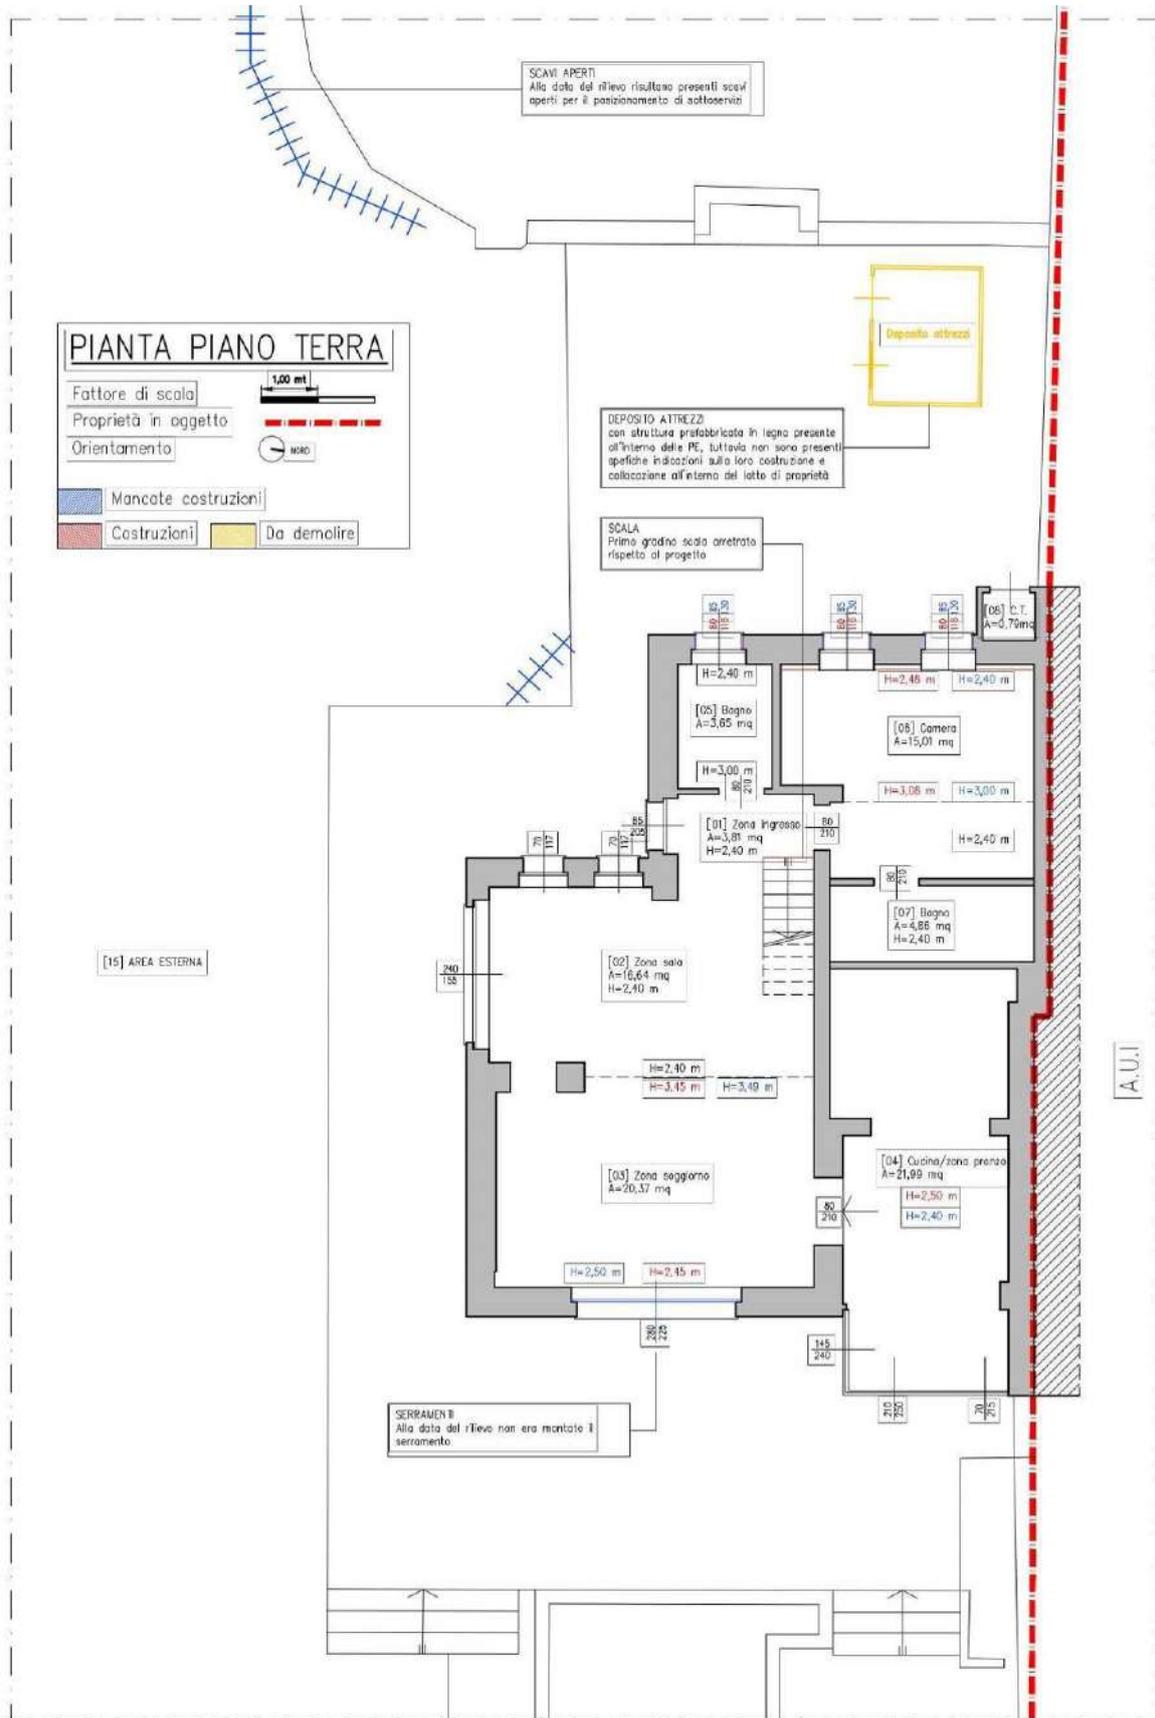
Pianta piano terra: confronto tra stato autorizzato e realizzato.
